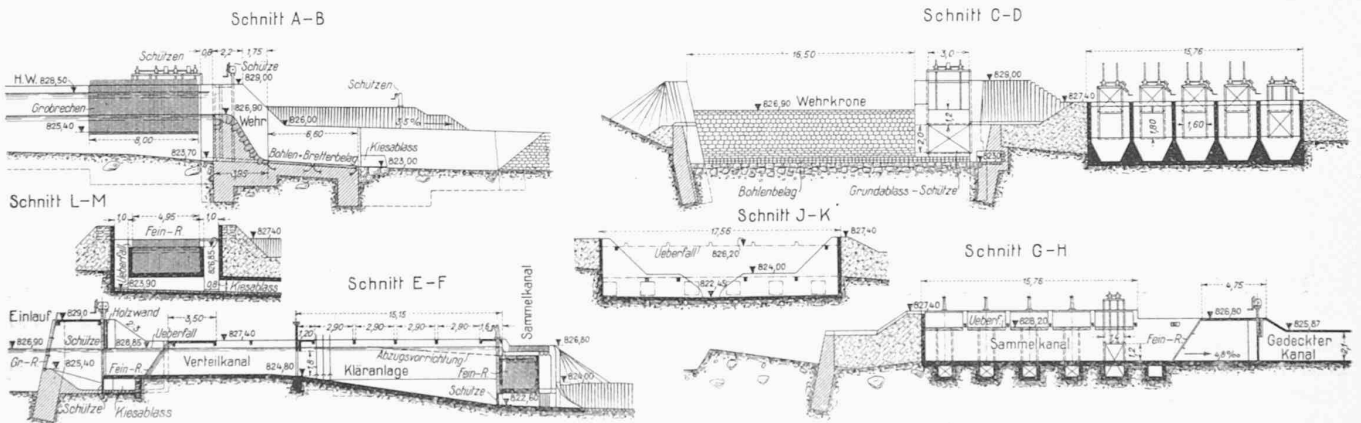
Schnitte der Kärstelenbach-Fassung und Kläranlage (vergl. Grundriss auf vorstehender Seite) — Masstab 1 : 500.
